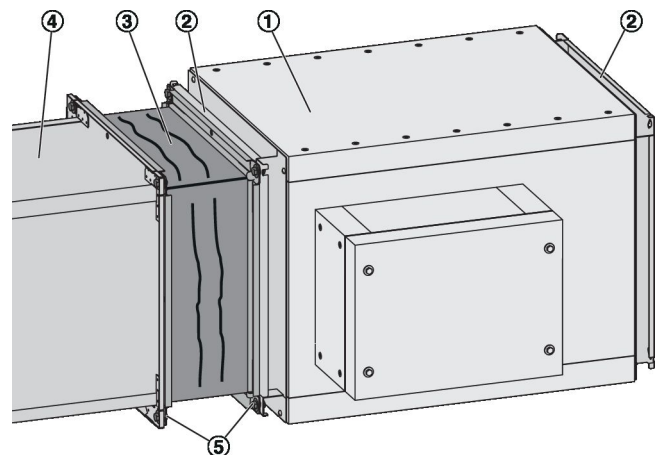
EK2-EU Anschluss an Stahlblech-Entrauchungsleitung
